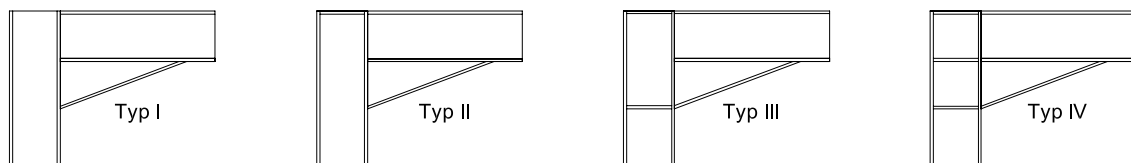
Untersuchte Ecktypen für Rahmen mit Riegeln aus Walzprofilen mit untergeschweißter Voute
